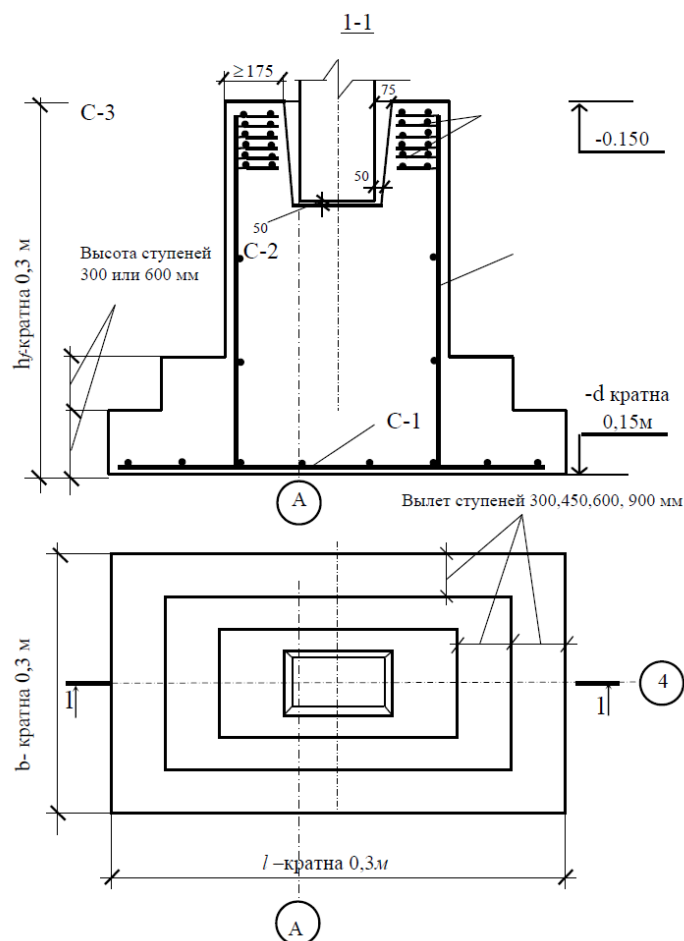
Армирование столбчатого фундамента под рядовую колонну
